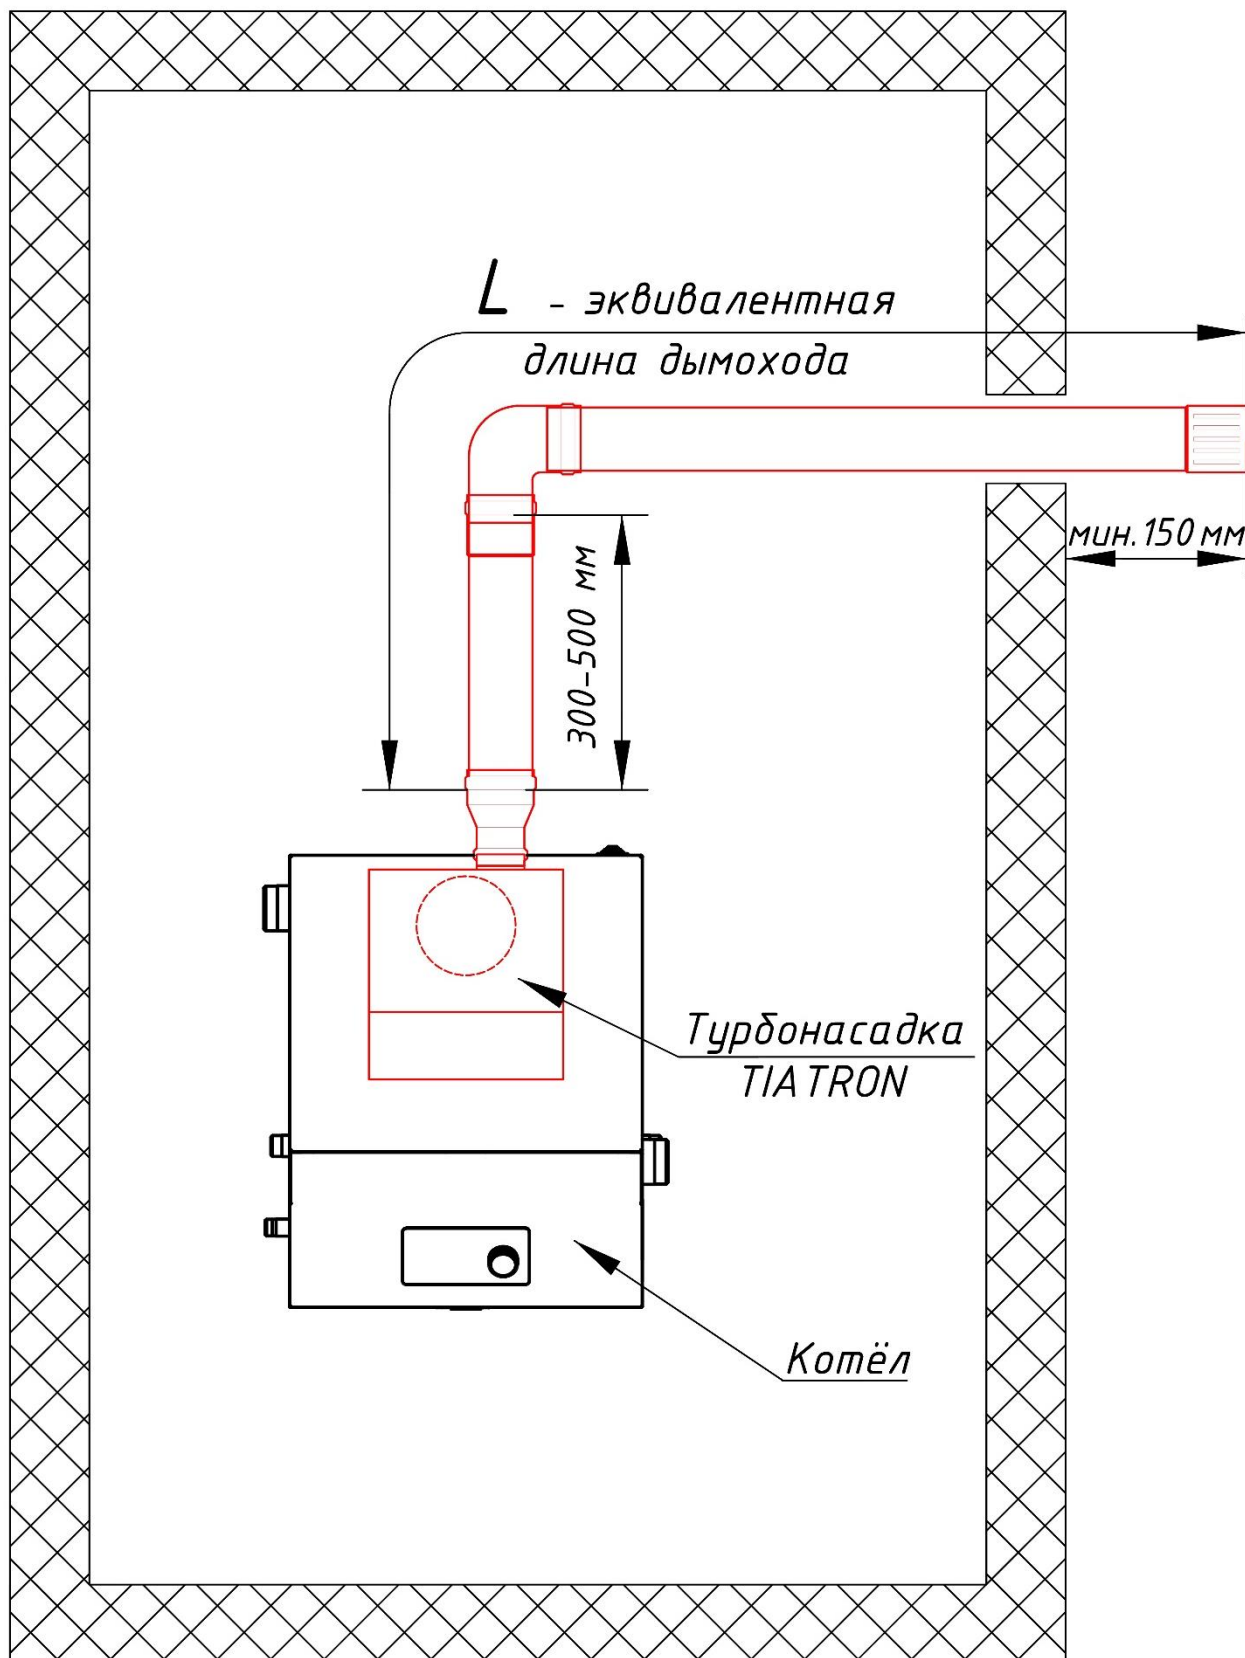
Пример монтажа турбонасадки на котел (вид сверху)
